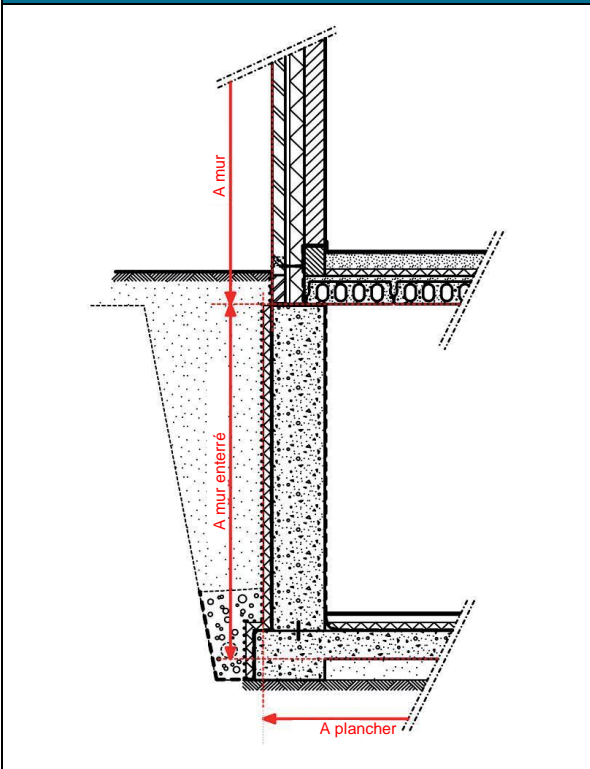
Mur extérieur – mur enterré – dalle contre terre lors d'une cave dans le VP
